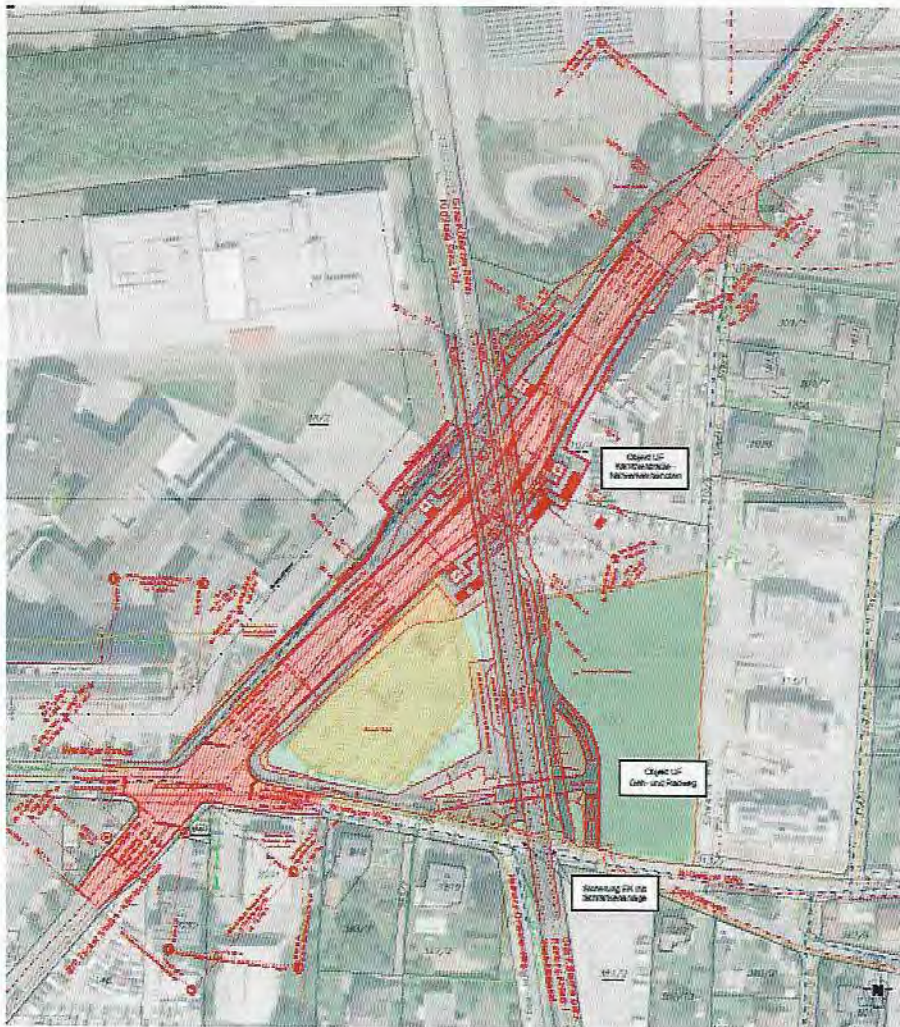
Straßenunterführung Kärntner Straße (Planung IKK Engineering GmbH)
